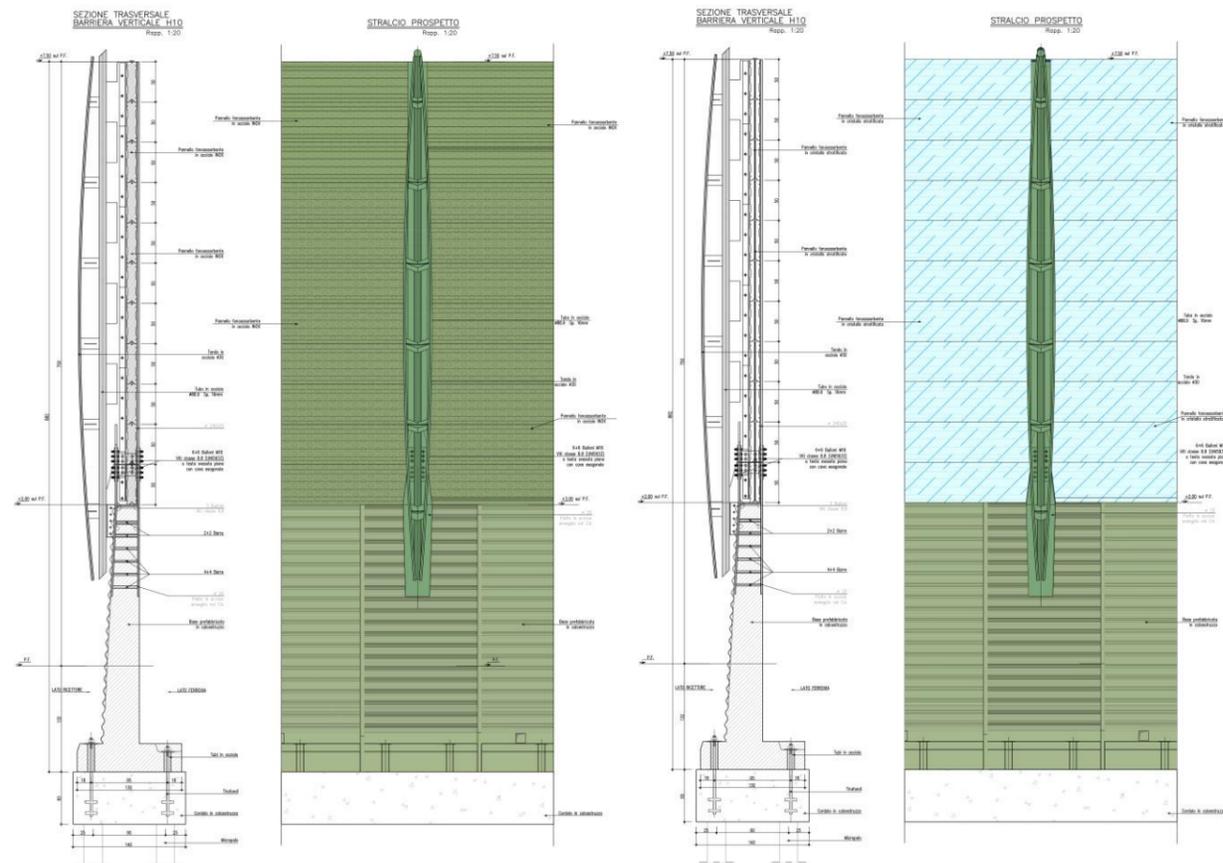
Sezione e prospetto delle barriere con pannellature opache e trasparenti
